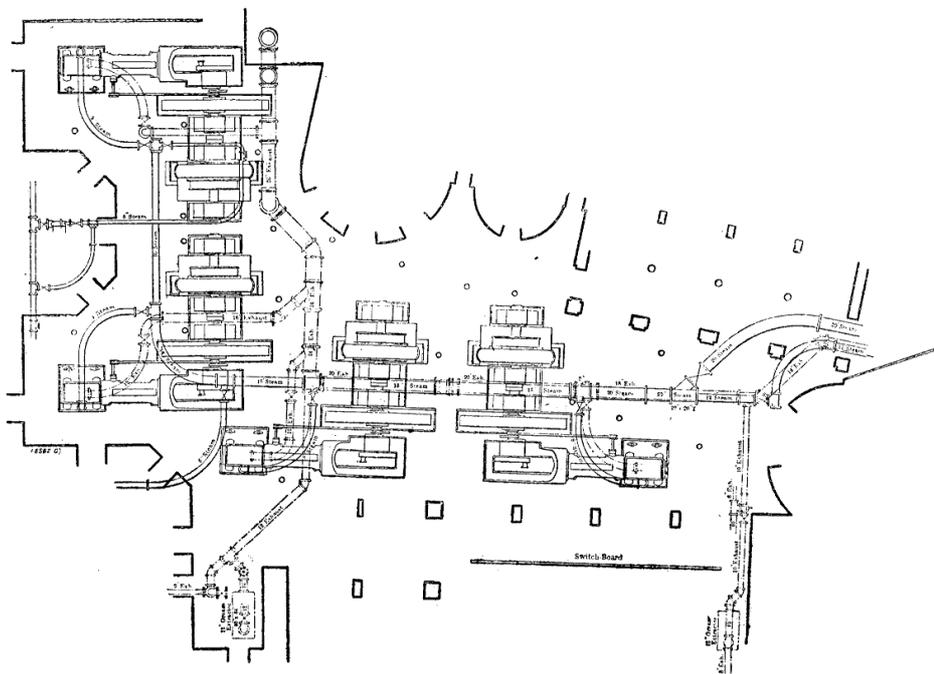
Machinerie du *Mutual life Building*. Salle des machines.
